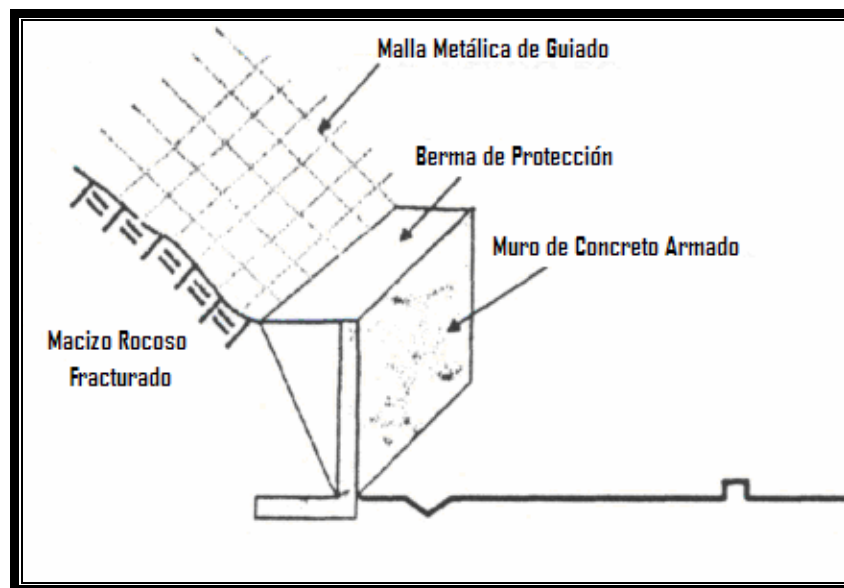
Muro de Concreto Armado con Malla de Guiado.
